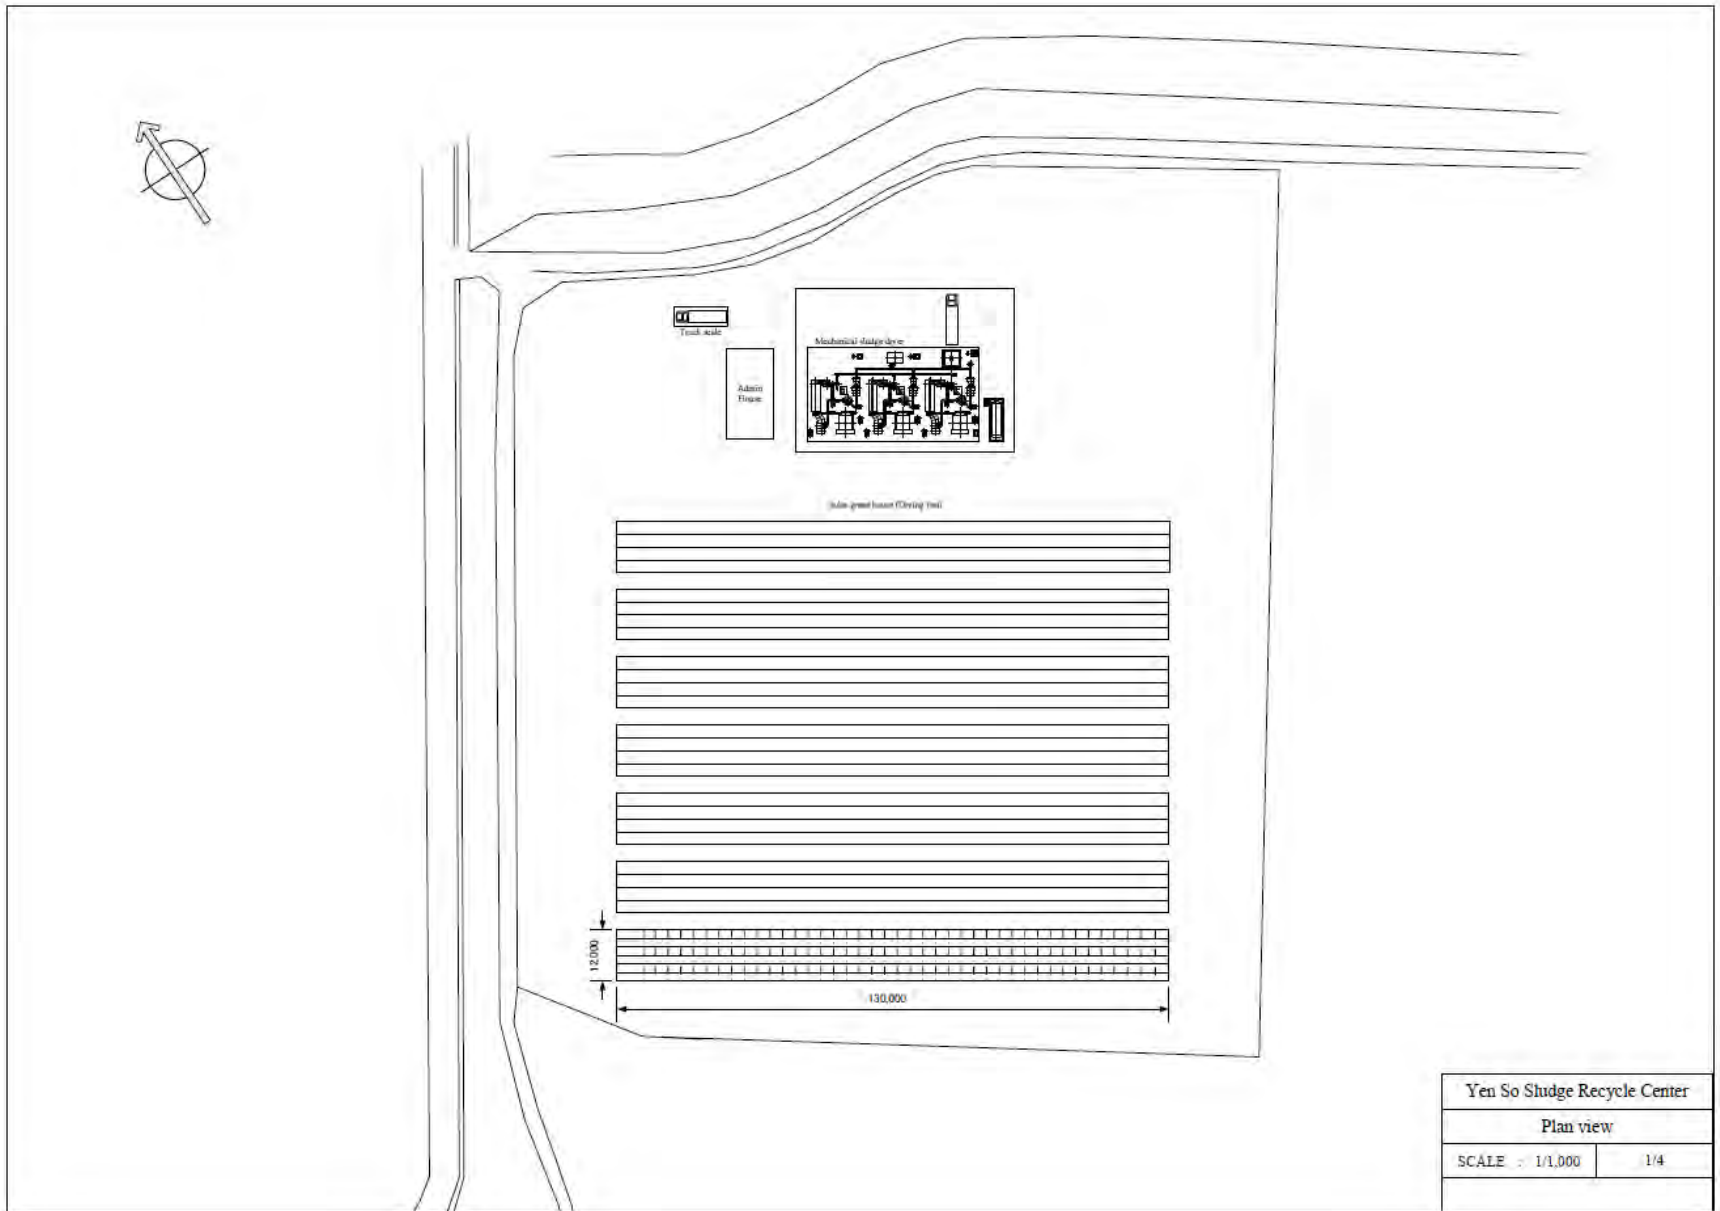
汚泥資源化センター平面配置図 (出典：JICA 調査団)
